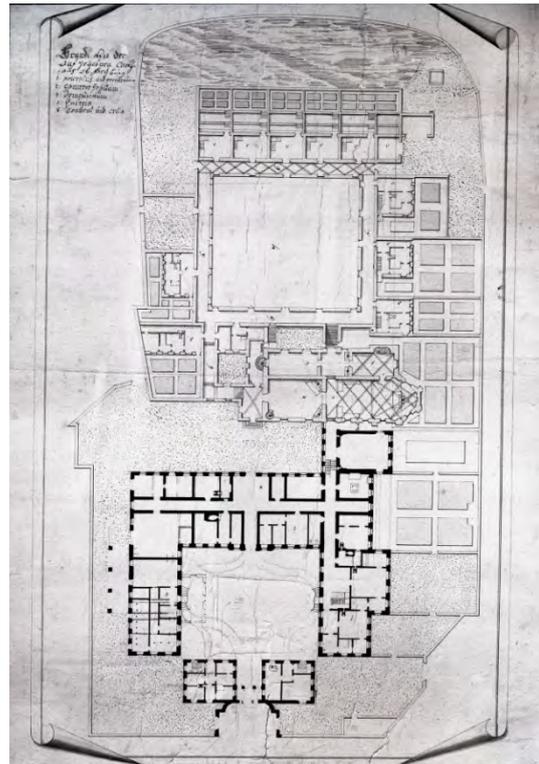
Historischer Grundriss der Kartause, nach 1782. Auf dem Plan sind die heute nicht mehr erhaltenen Mönchszellen abgebildet. Stadtarchiv Freiburg, M 10/52. Foto: Frank Hack.
